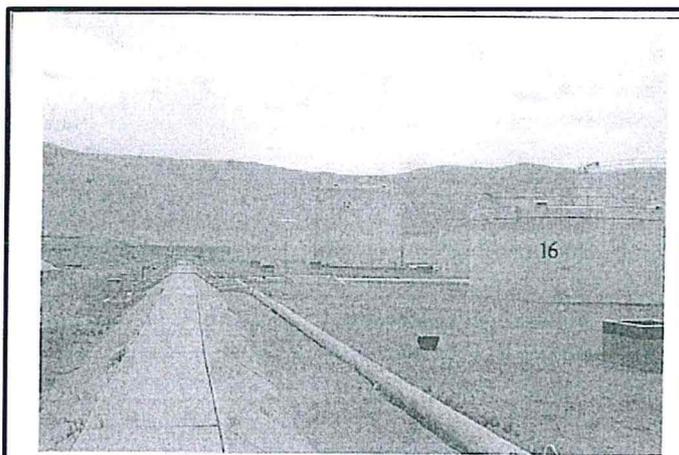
Área de tanques. Zona estanca sin impermeabilizar
